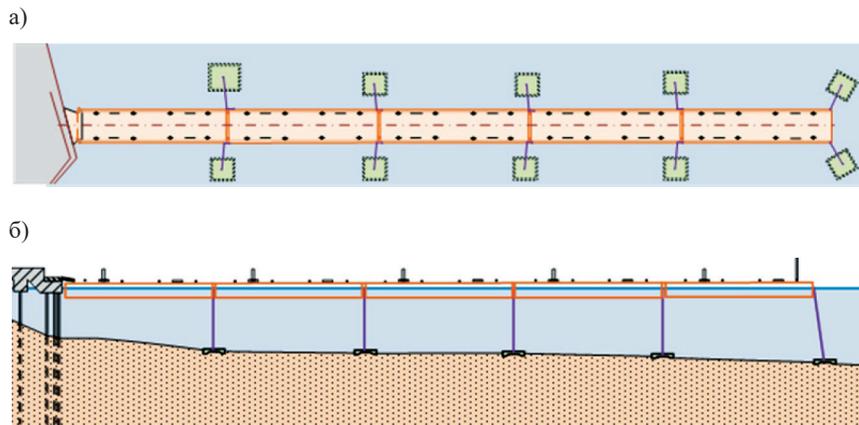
Плавающий причал: а — вид сверху; б — разрез
